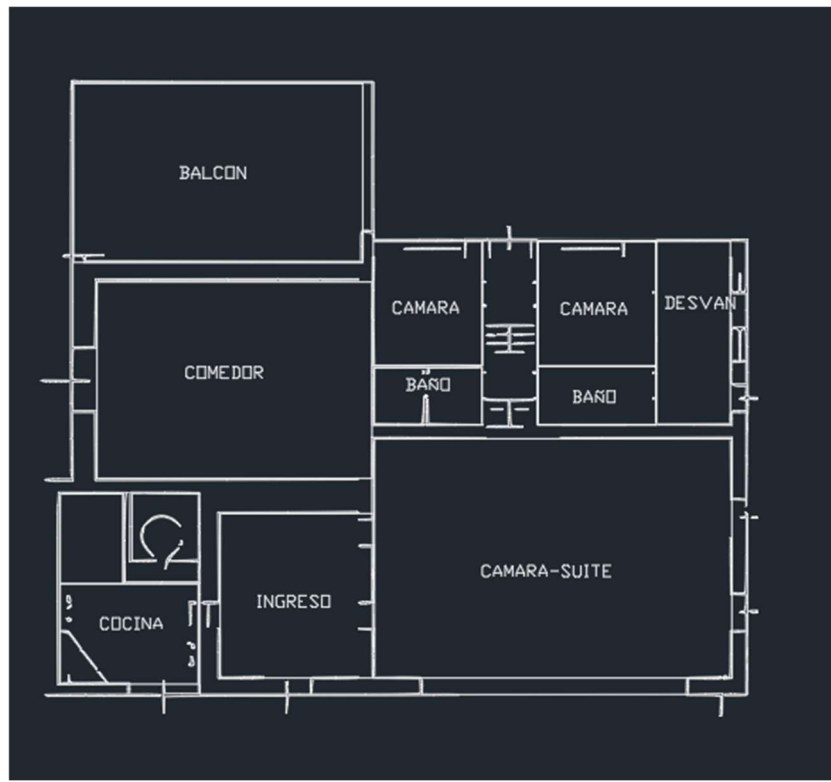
Plano de la planta baja de la primera inmediación. Elaboración propia
